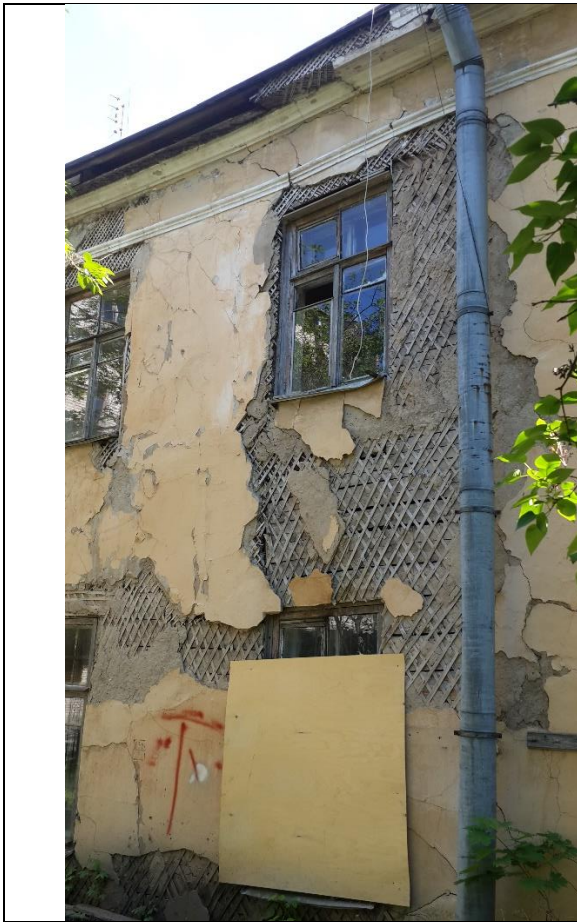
Перекосы стен, выпучивания отдельных бревен, трещины, вызванные неравномерными осадками фундамента
